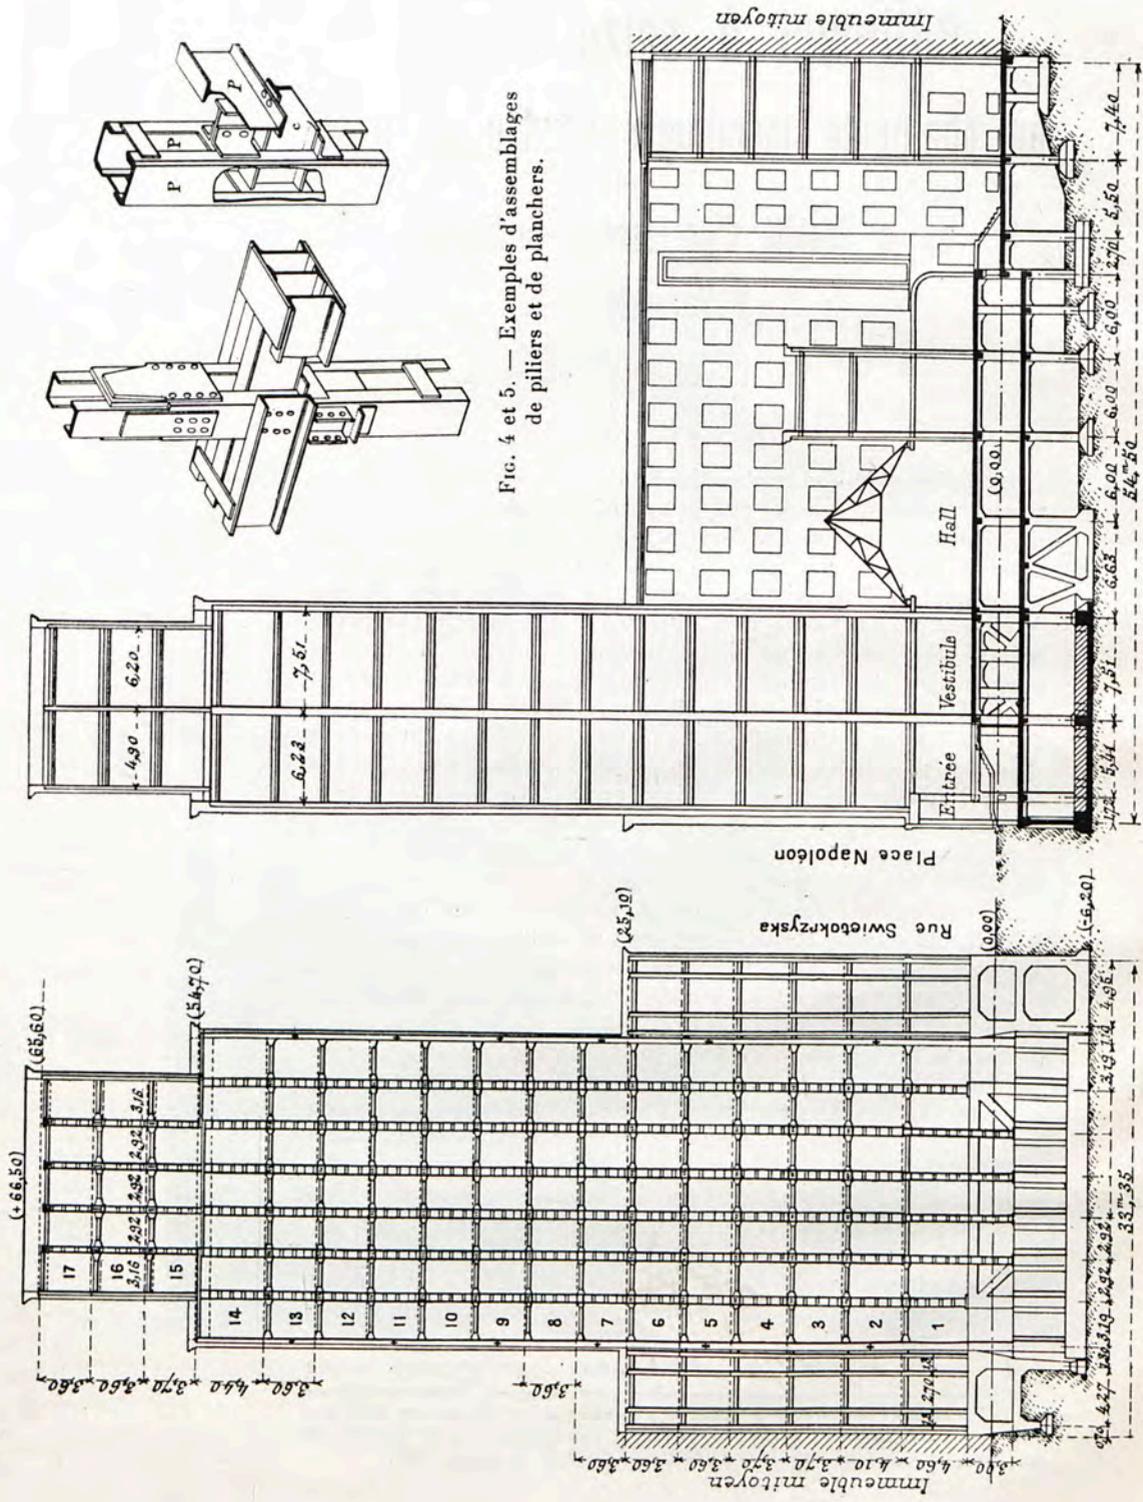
et 5. — Exemples d'assemblages de piliers et de planchers.
